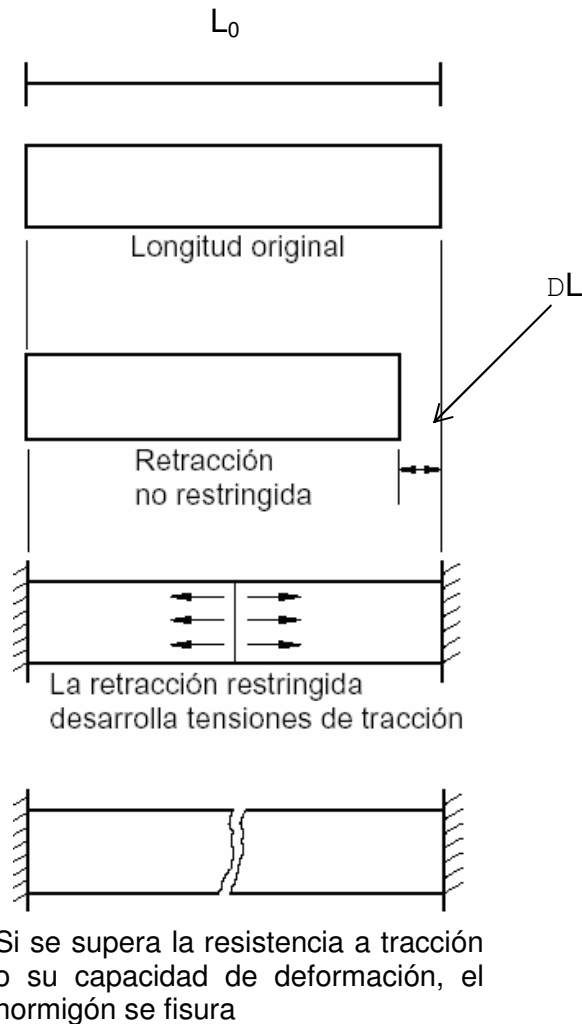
Fisuración provocada por retracción por secado
